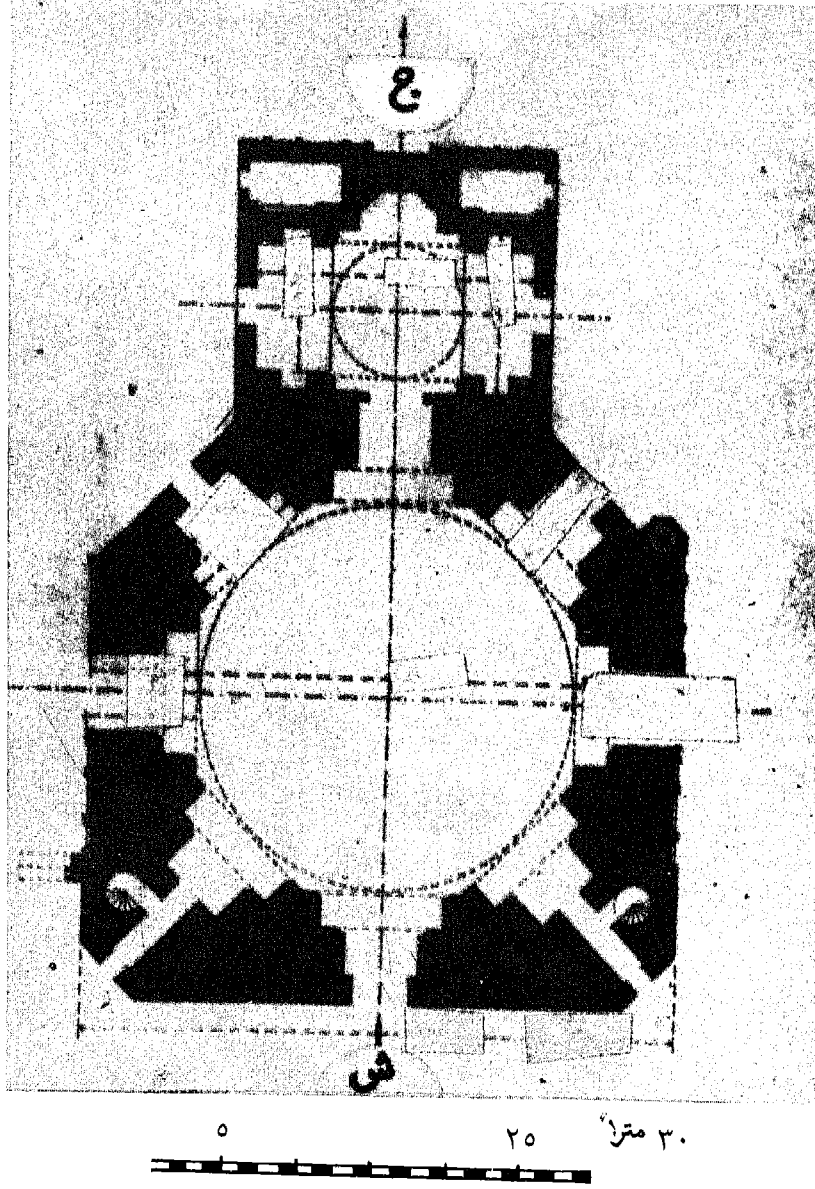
مسقط أفقي لقصر الحمراء بغرناطة
